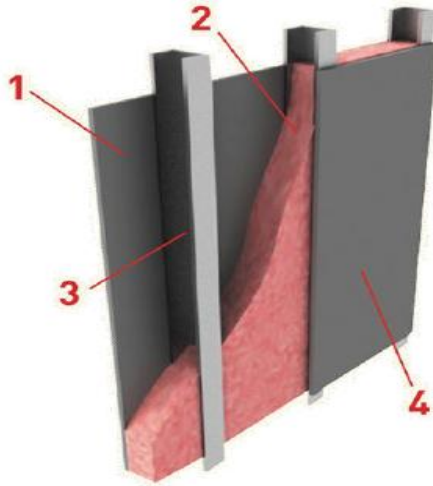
Утепленная перегородка: 1, 4 – листы из гипсокартона; 2 – тепловая изоляция; 3 – каркас из металлического профиля
